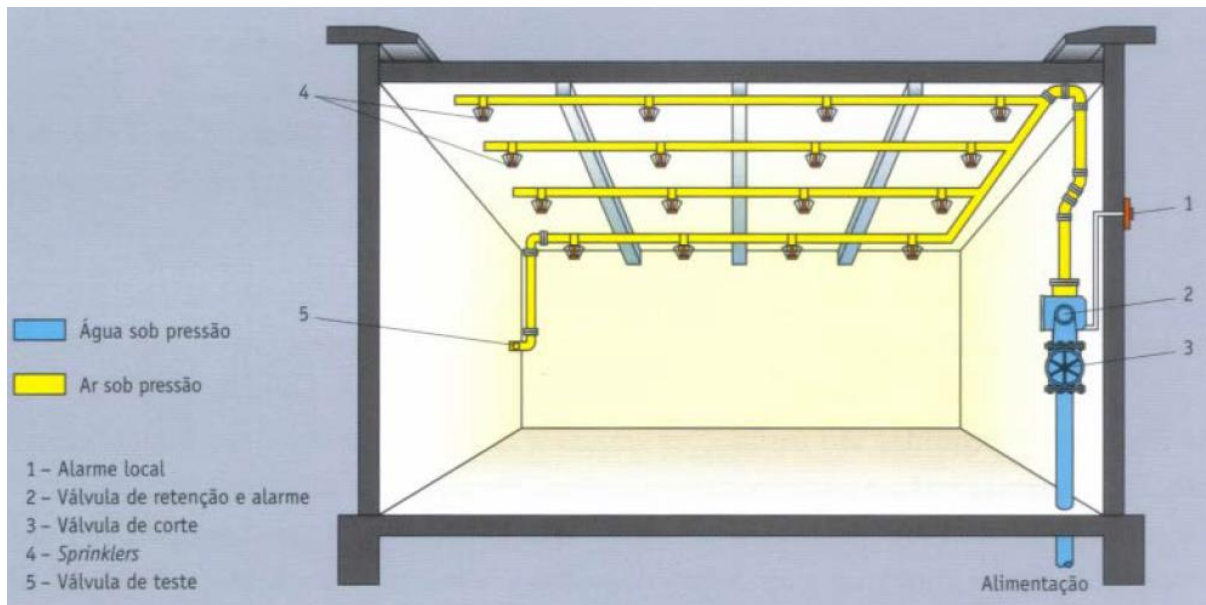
Sistema seco (*dry pipe system*) (Castro, Abrantes, 2009)
